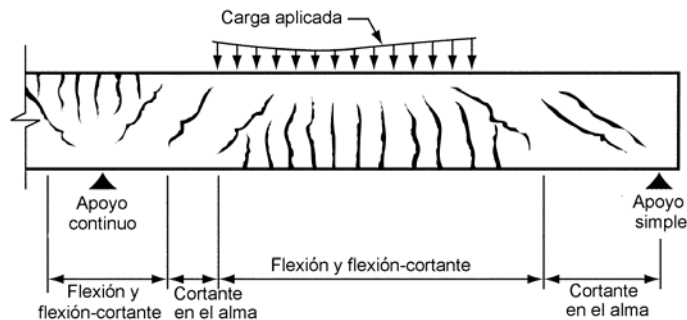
Tipos de agrietamiento en vigas de concreto.
